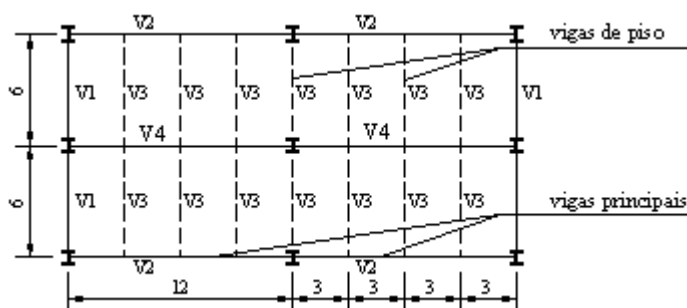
Planta esquemática do vigamento de piso (medidas em m)
